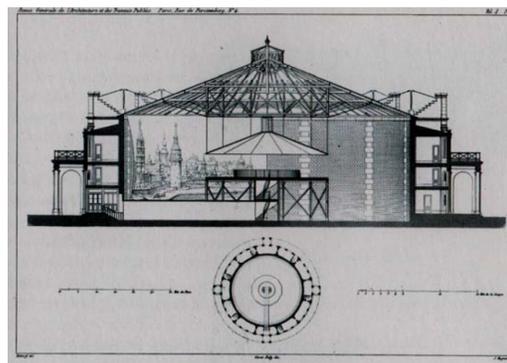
Corte esquemático e planta da plataforma do projeto do arquiteto Hittorff.
